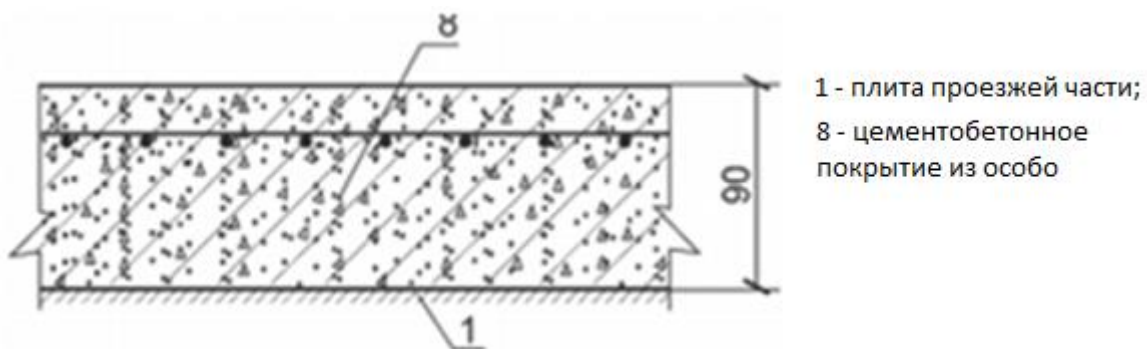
Конструкция дорожной одежды на железобетонной плите с применением цементобетонного покрытия из особо плотного бетона, выполняющего гидроизолирующие функции, или из фиброцементобетона
